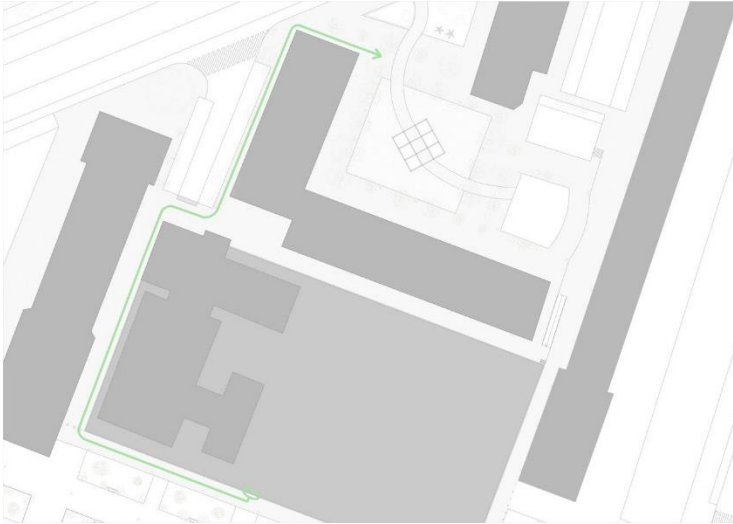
Recorrido 3 puerta calle Campoamor.
